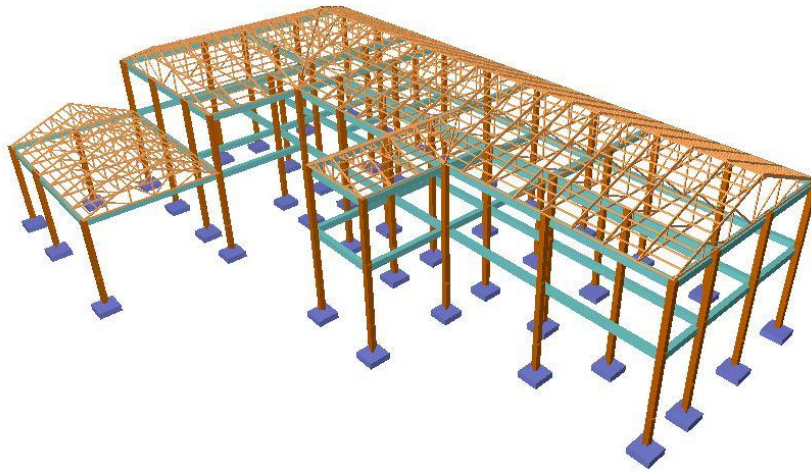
Vista 3D de la cubierta del Bloque Aulas
